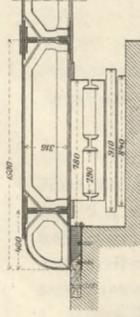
Schnitt hi. Section hi, showing the details of the structure.
